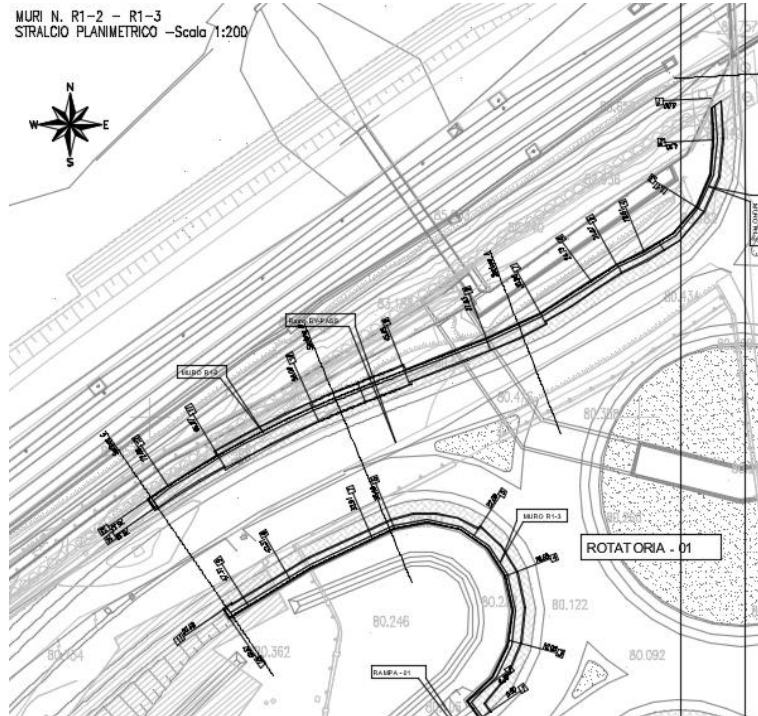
Stralcio planimetrico Muro R1-2 e R1-3
